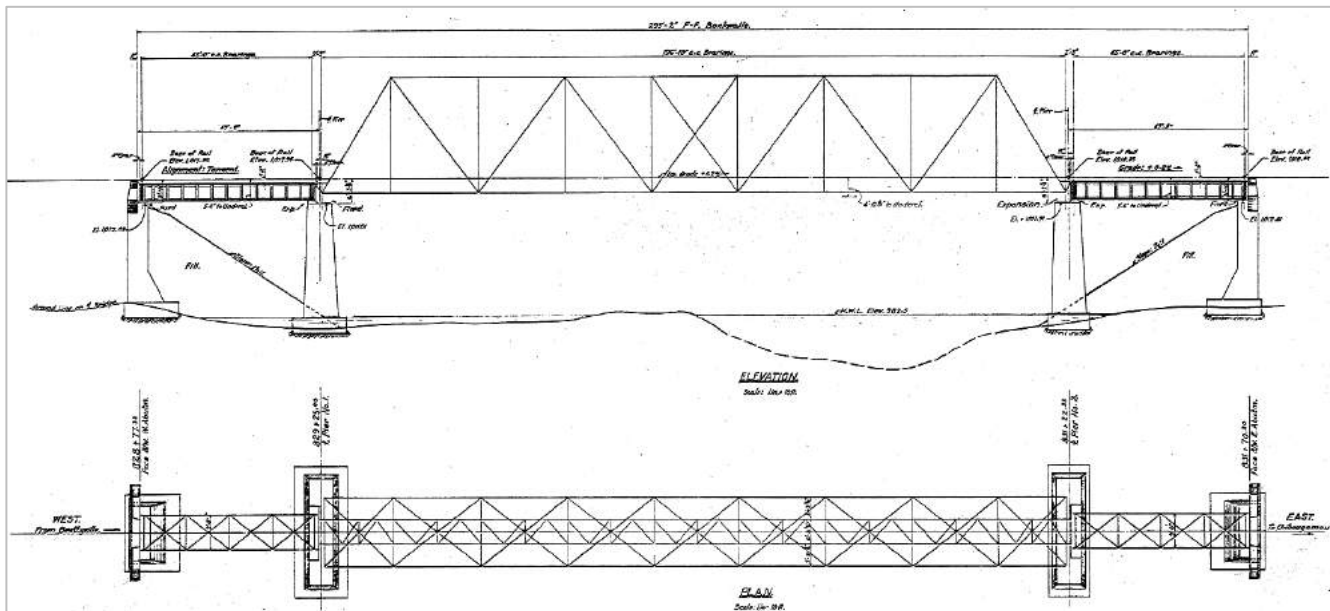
Vues en plan et en élévation du pont PM 125.30 Chapais
